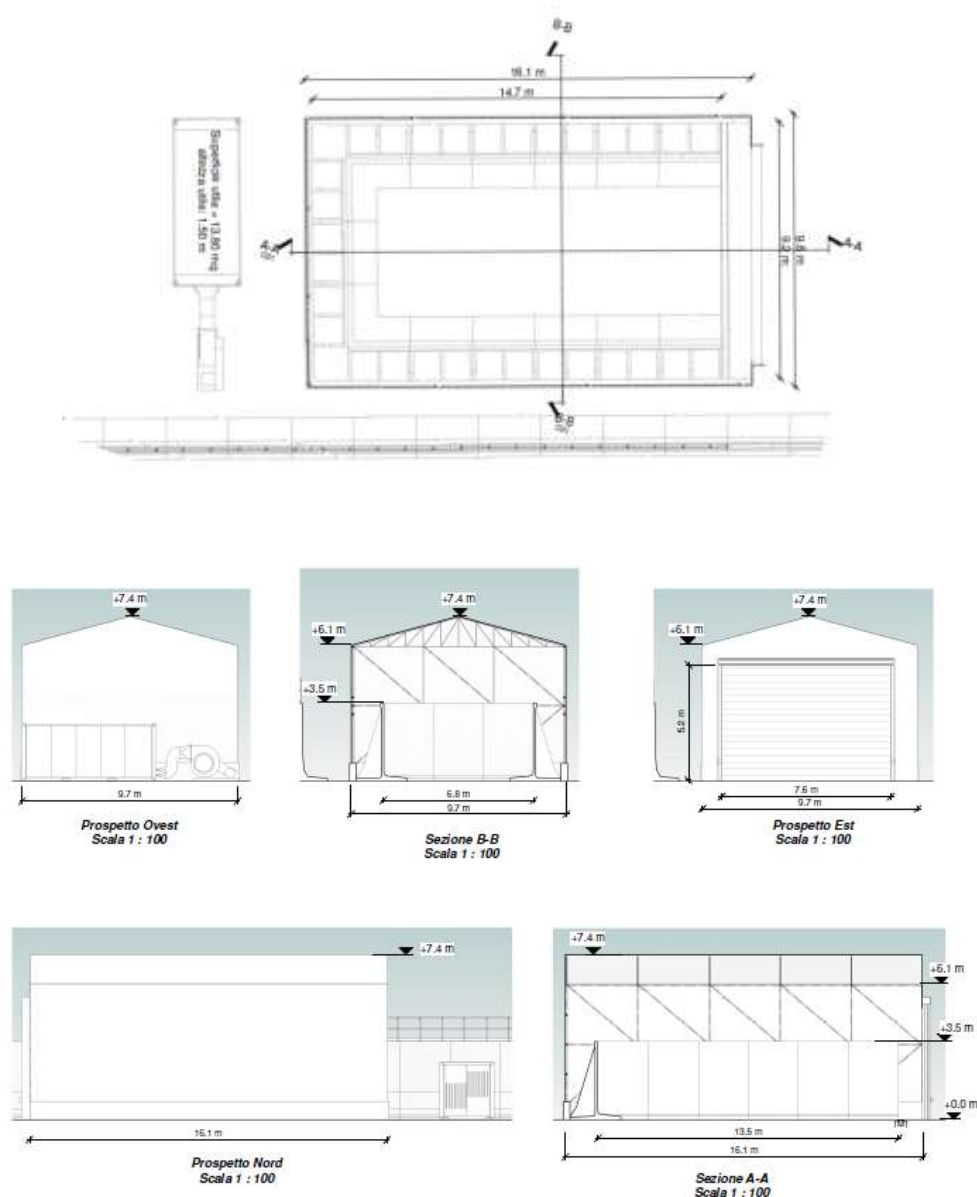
Pianta e sezione capannone stoccaggio pollina e biofiltro
